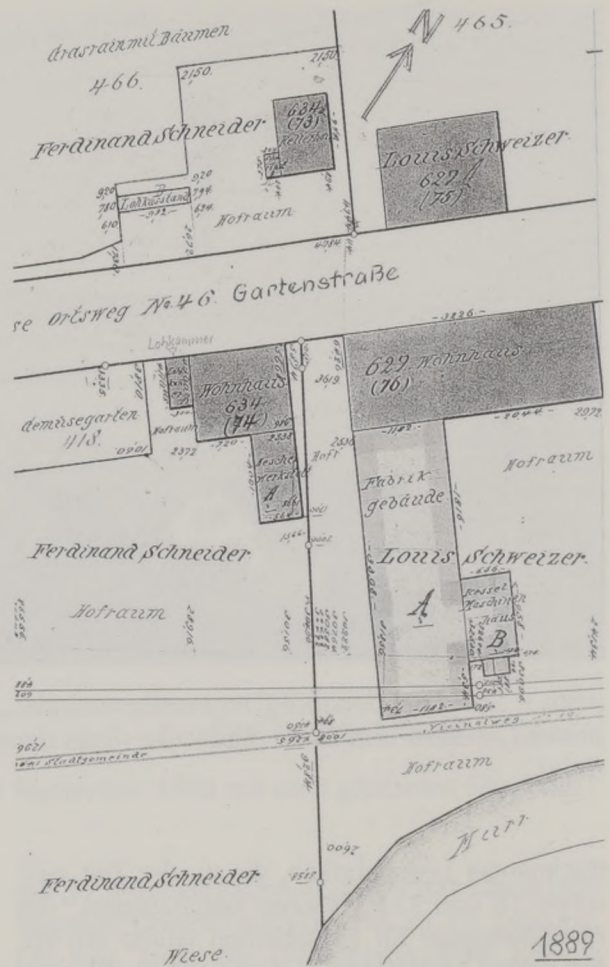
Lageplan der Rotgerberei Ferdinand Schneider sen., Gartenstraße 73/74 im Jahr 1889.
